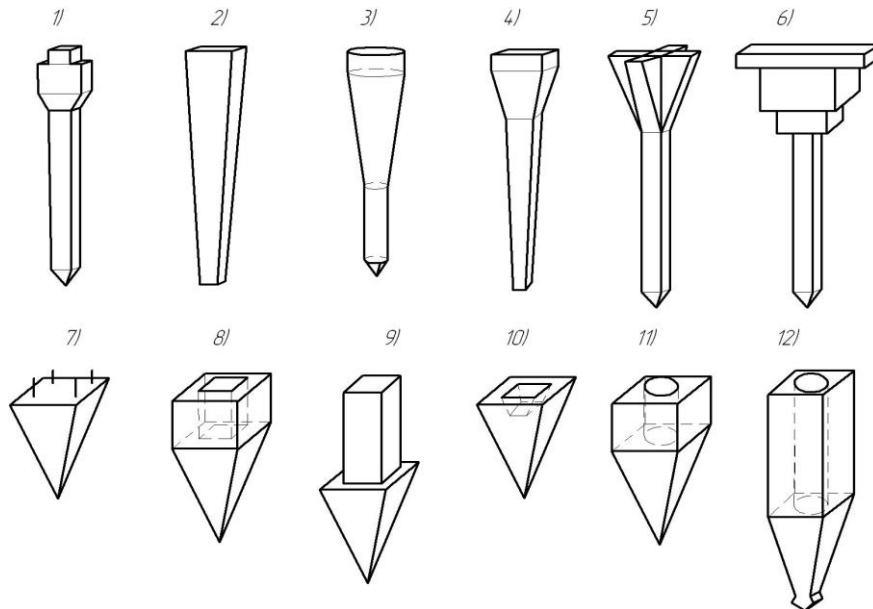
Виды готовых железобетонных свай с уширениями вверху:
